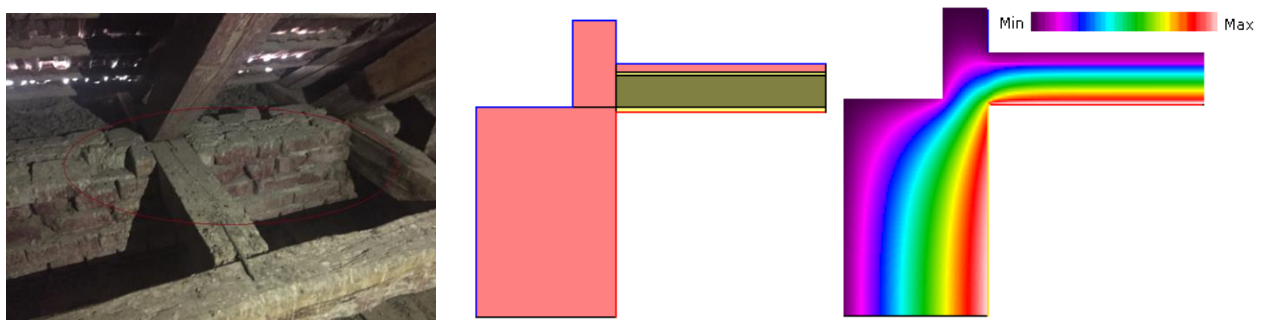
Detaliu intersecție perete exterior P1 cu planșeu din lemn, sub pod P11 (secțiune verticală)
